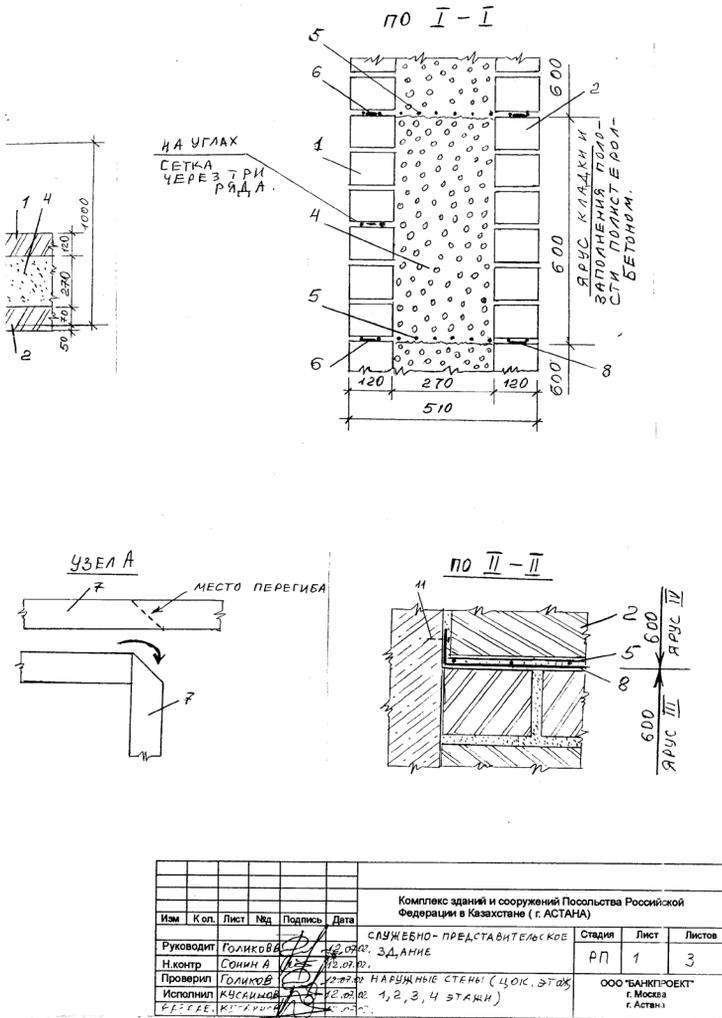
Конструкция облегчённой, самонесущей кирпичной наружной стены здания Российского посольства в Астане: 1 – наружная верста из лицевого, полнотелого кирпича; 2 – внутренняя верста из силикатного кирпича; 4 – пенополистиролбетон; 5 – арматурная сетка связывающая вёрсты кладки; 6 и 8 – анкерные пластины для крепления стены к колоннам каркаса.
